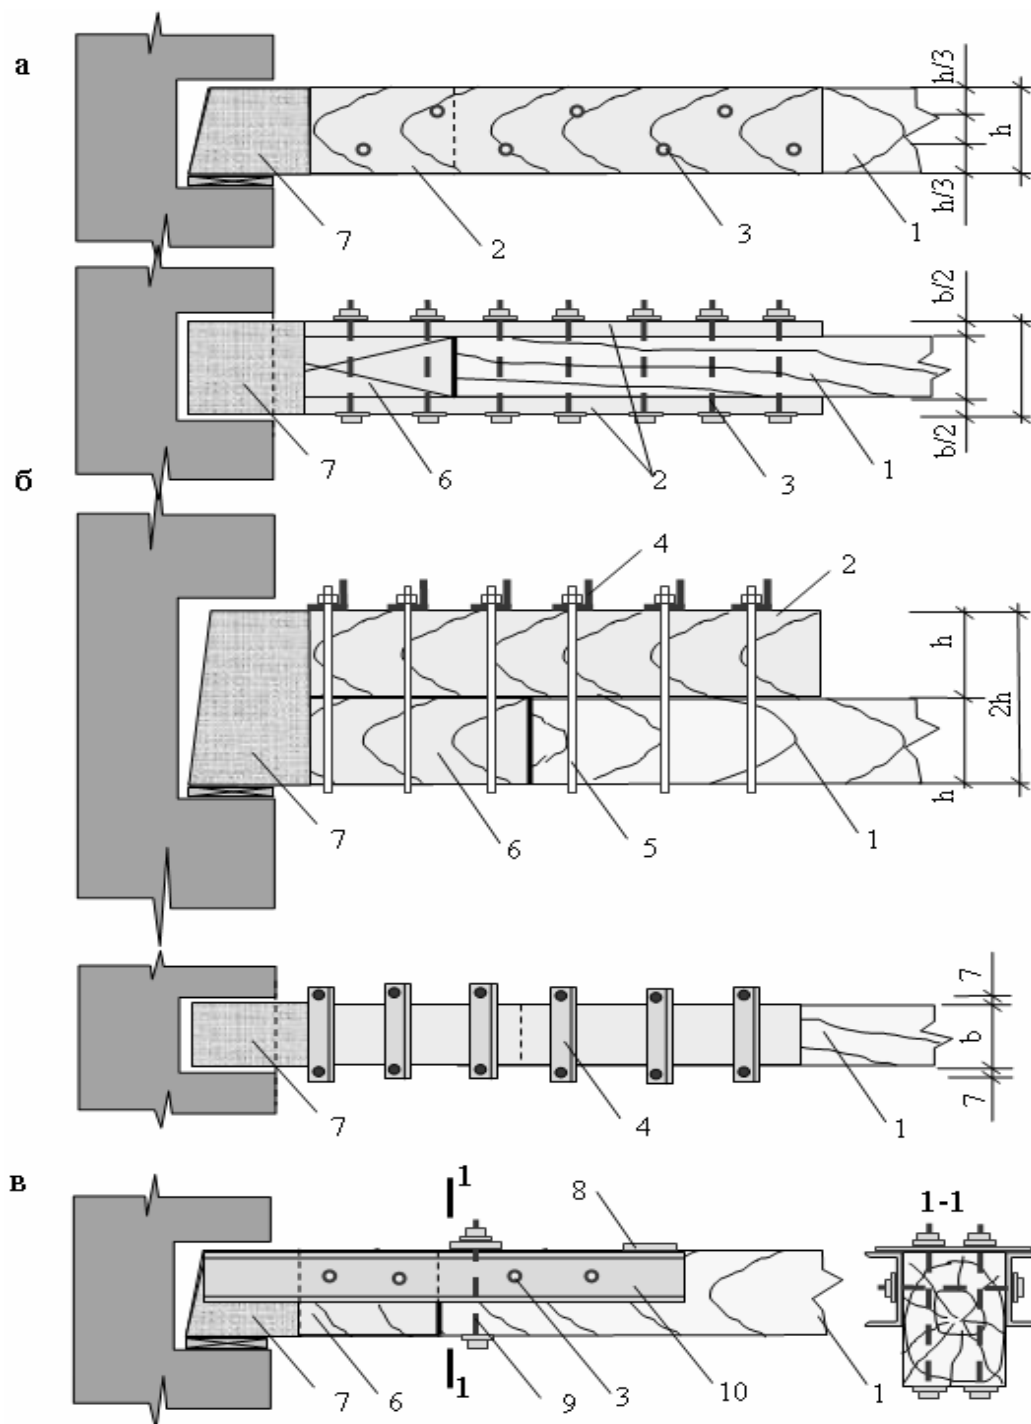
Усиление опорных участков деревянных балок накладками: *а* – деревянными со стороны боковых граней, *б* – деревянной со стороны верхней грани, *в* – стальными со стороны боковых граней; 1 – усиливаемая балка, 2 – накладки из новой древесины, 3 – болты, 4 – уголок, 5 – хомут, 6 – деревянный вкладыш, 7 – гидроизоляция, 8 – соединительная планка, 9 – стяжной болт, 10 – накладка из швеллера
